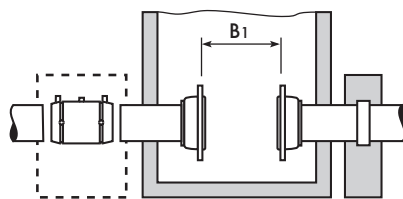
Монтаж бетонной опоры на электросварную муфту
